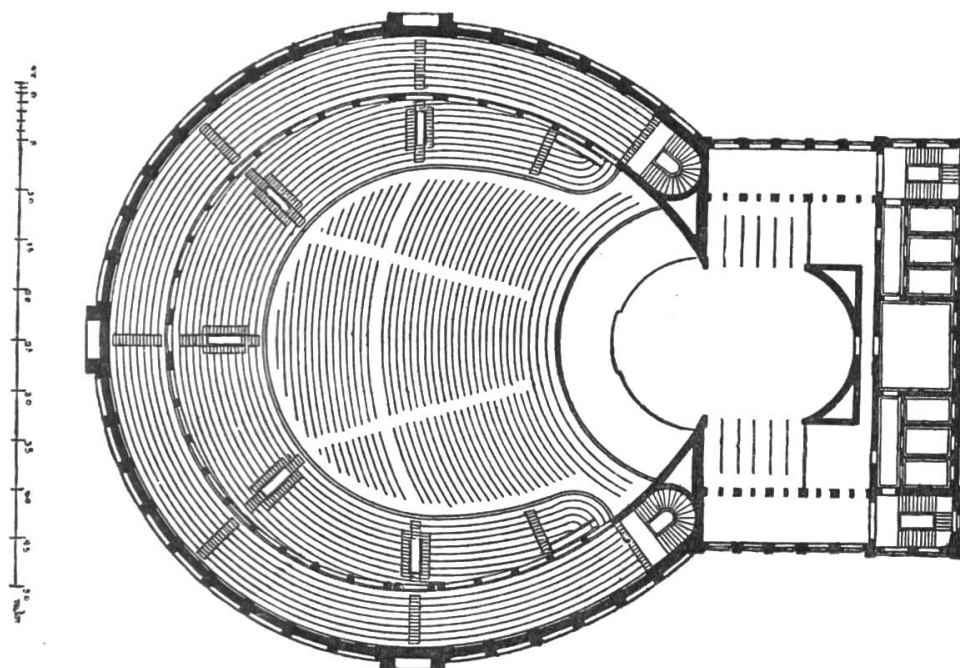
Projekt für eine Volksoper in Paris 1875. Grundriss.
